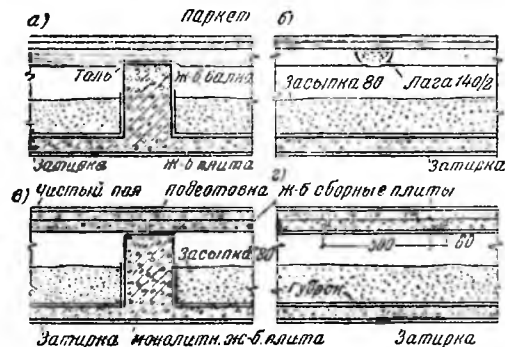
Ребристое железобетонное перекрытие с ребрами, обращенными вверх
